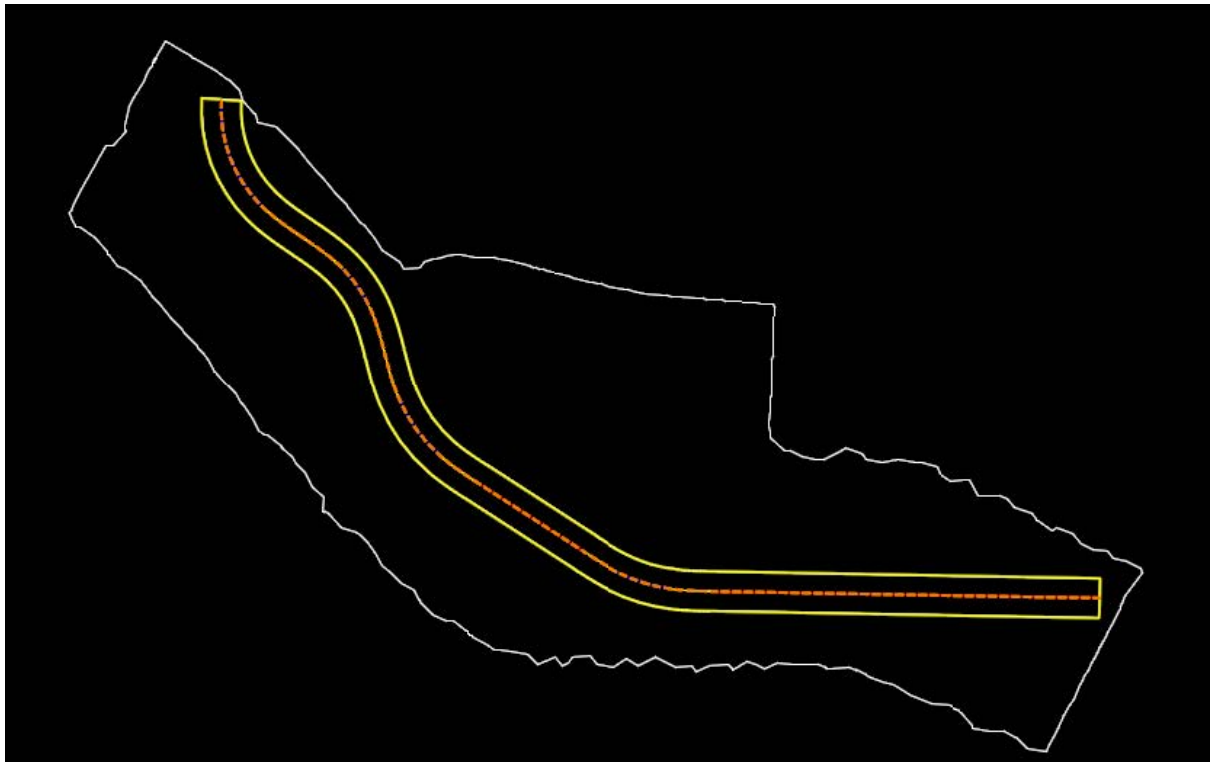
Sopraelevazione del tracciato vista in pianta
